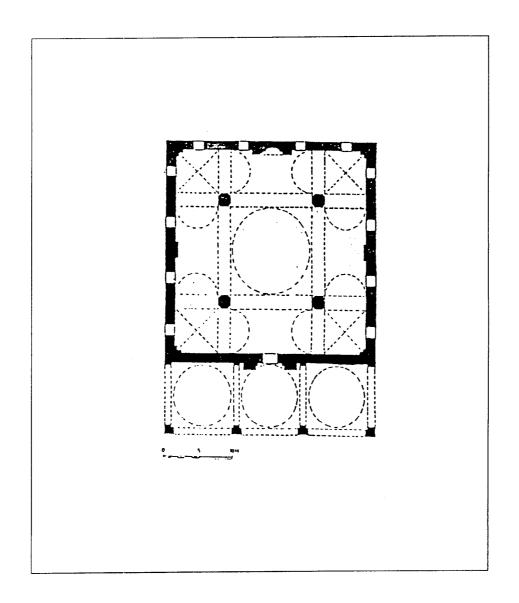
مسقط أفقي لمسجد أحمد بك أورنوس أوغلو في يانيس فردار (عن : كيل) .
